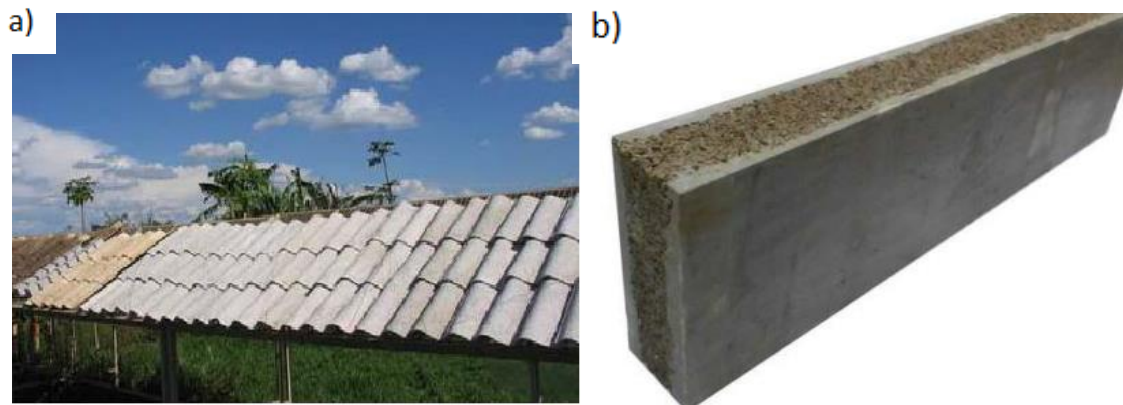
Utilização dos compósitos reforçados por fibras vegetais. a) Aplicação em telhas (TONOLI, 2006) b) Aplicação em painéis sanduíche (GLORIA, 2015)
